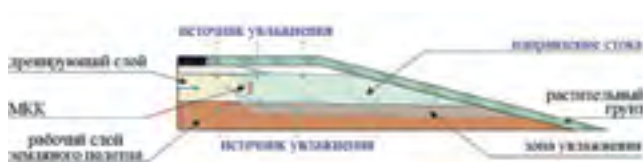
1. Увлажнение рабочего слоя земляного полотна и грунта обочины при размещении ЛКС ТМК в дренирующем слое
